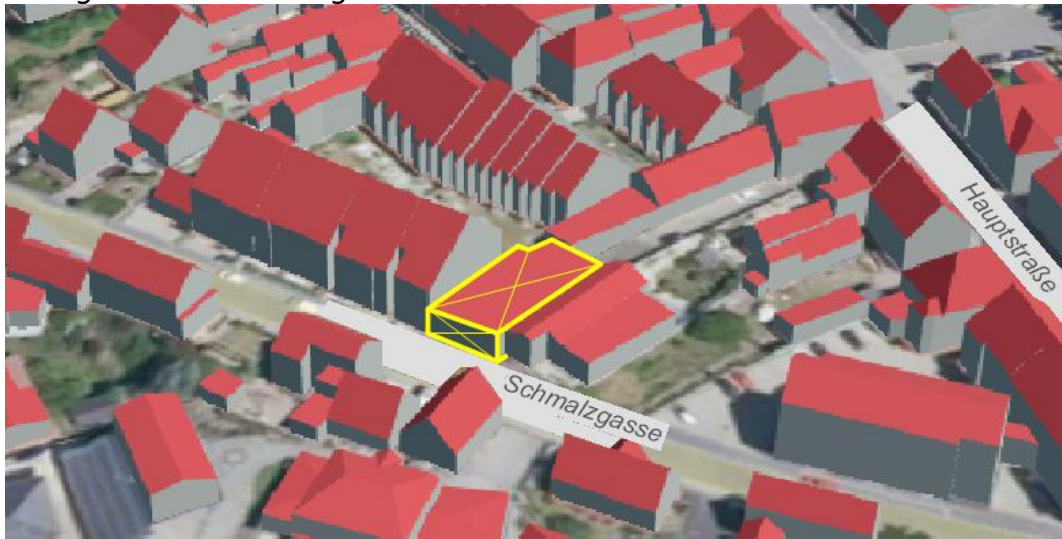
Vogelperspektive von Südwesten zum Anwesen Schmalzgasse 10 mit gelb markierter abzubrechender Scheune. Neu geplant ist ein E+O+D-geschossiges Wohnhaus mit drei Wohnungen, welches die volle Grundfläche des Baugrundstückes einnimmt. Die Zufahrt, die Stellplätze, sowie die Technik- u. Nebenräume sind im Erdgeschoss vorgesehen. Das Obergeschoss soll die komplette Wohnung WE 1 aufnehmen. Vom 1. Dachgeschoss aus reichen
